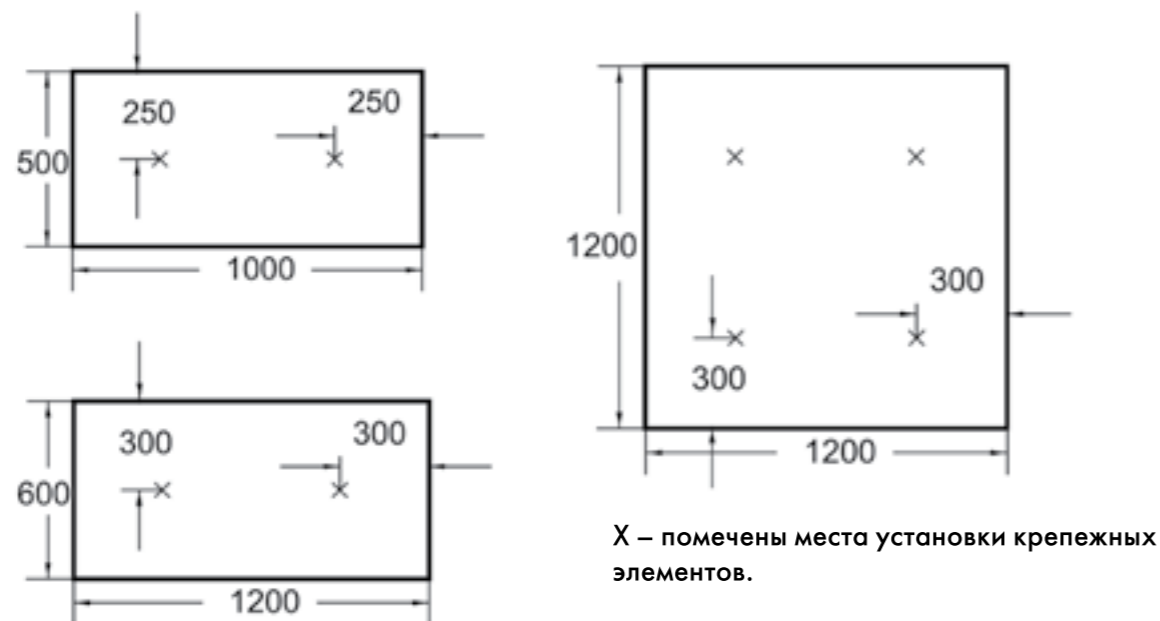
Крепление плитной теплоизоляции.
